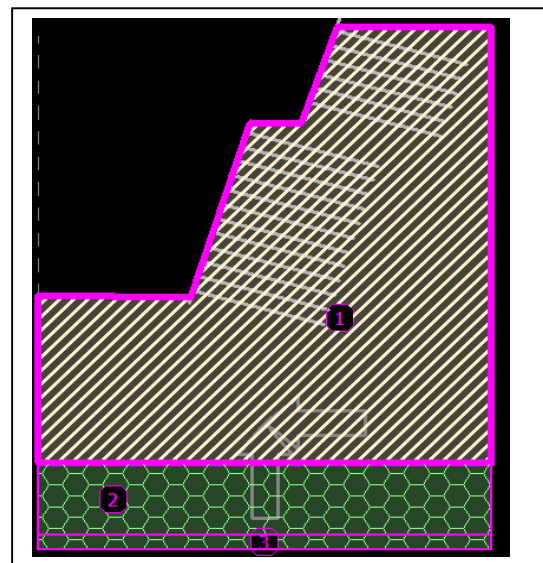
Talus droit à la sortie du tunnel avec soutènement
